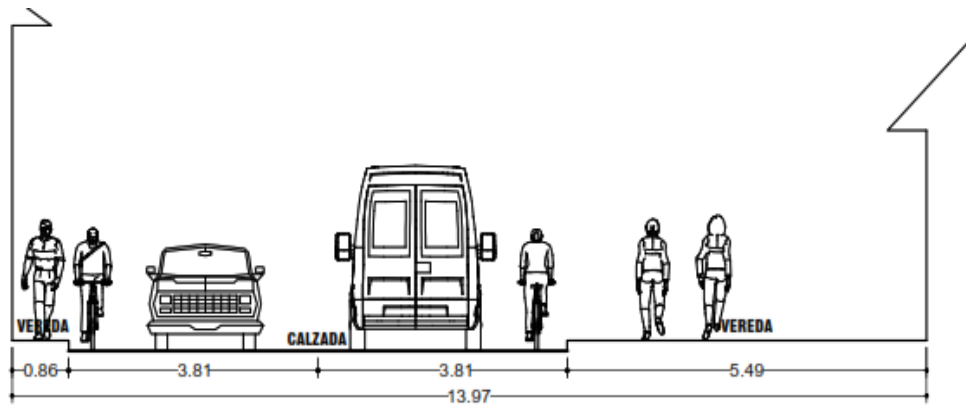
Propuesta de rediseño intersección Calle Mantas – Av. El Sol
